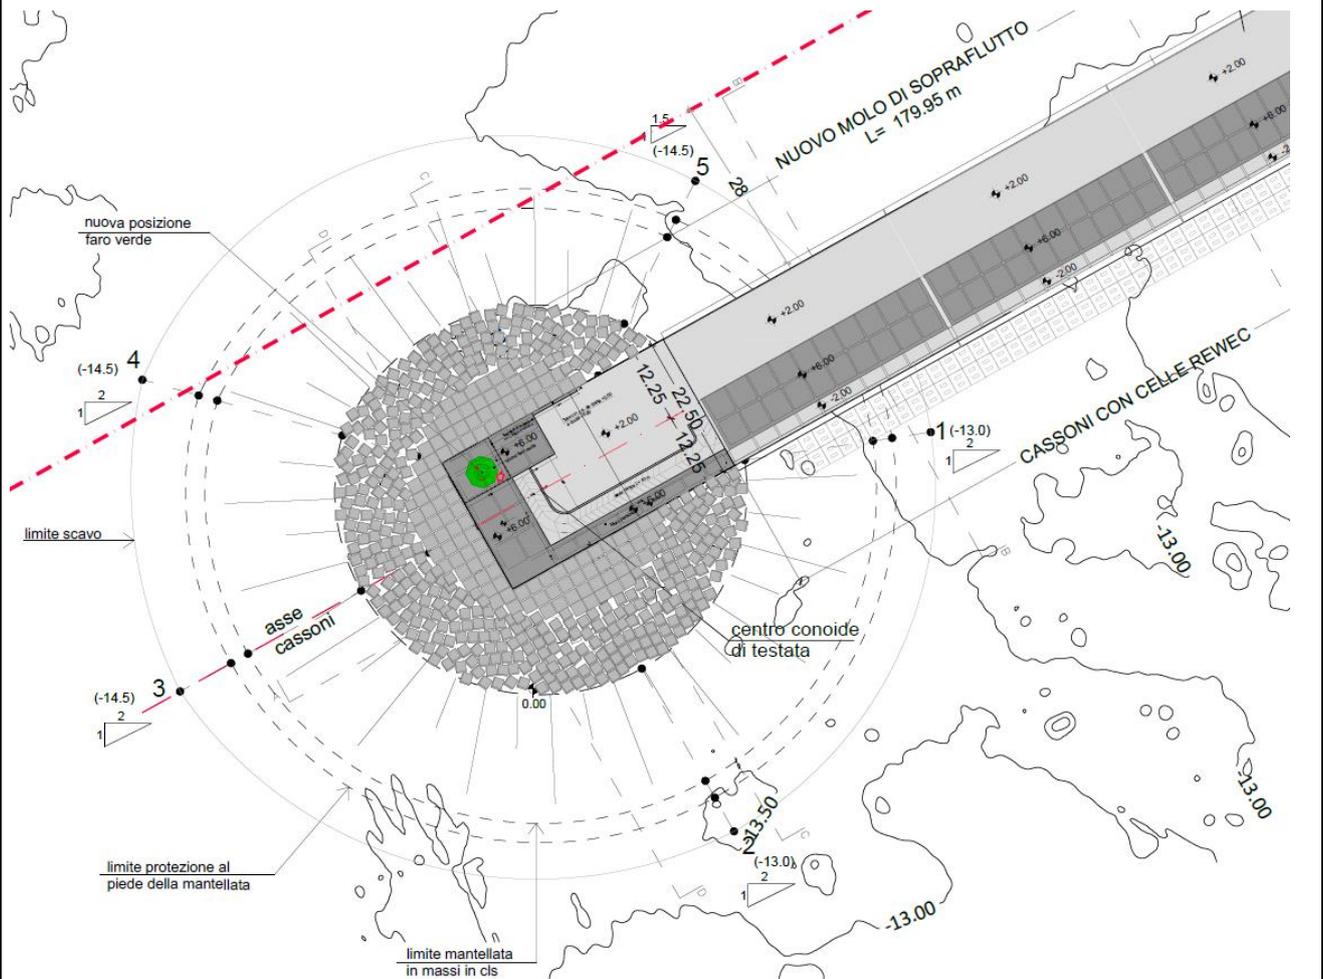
Progetto Esecutivo: Prolungamento Molo Sopraflutto – stralcio planimetrico conoide di testata
